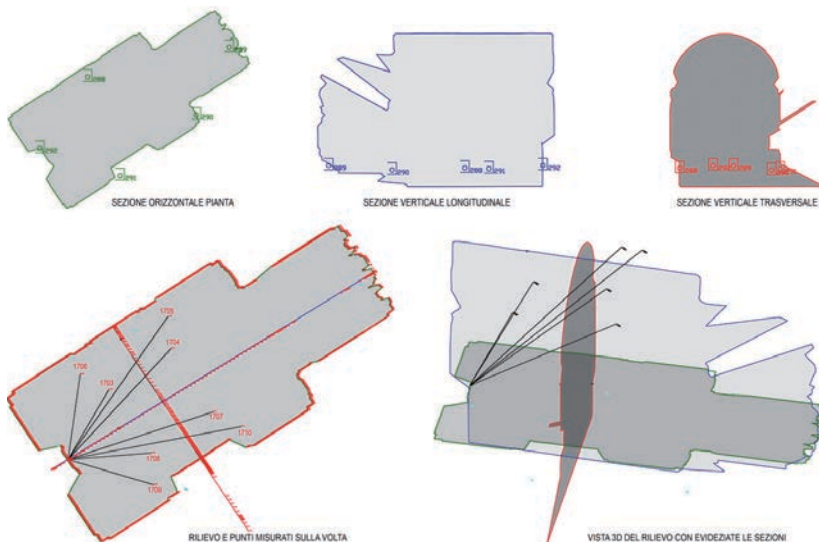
Chiesa di Santa Maria delle Grazie a Crema: profili rilevati con il Disto-Laser 3D della Leica: pianta, sezione longitudinale e sezione trasversale.
